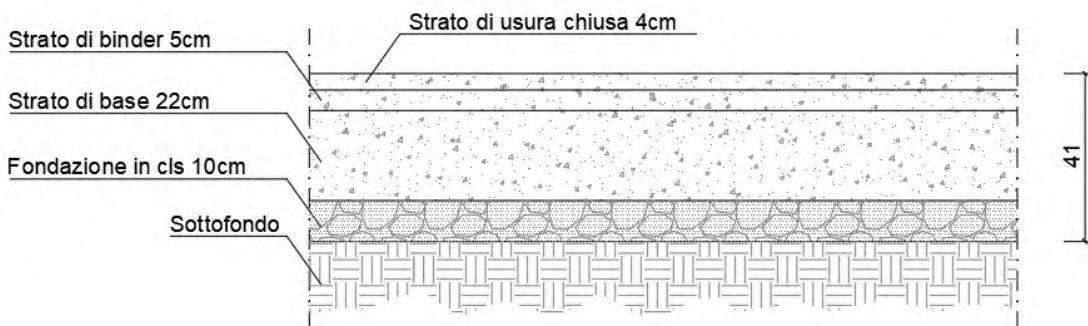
Pacchetto di ripristino pavimentazione nei sottovia TIPO P4C
